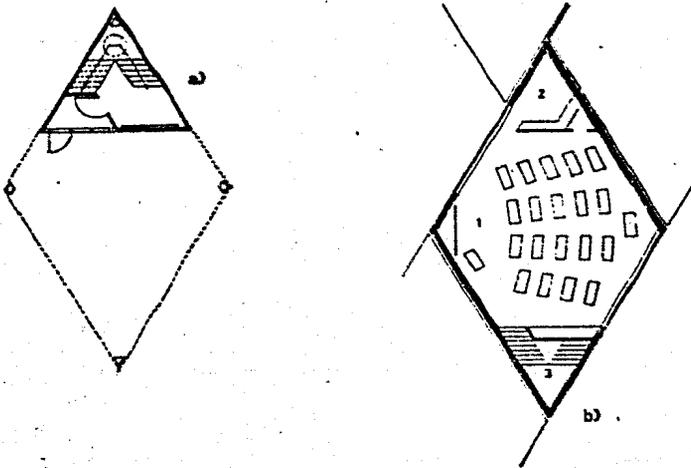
Planta del pabellón escolar «Tri-gón»:
